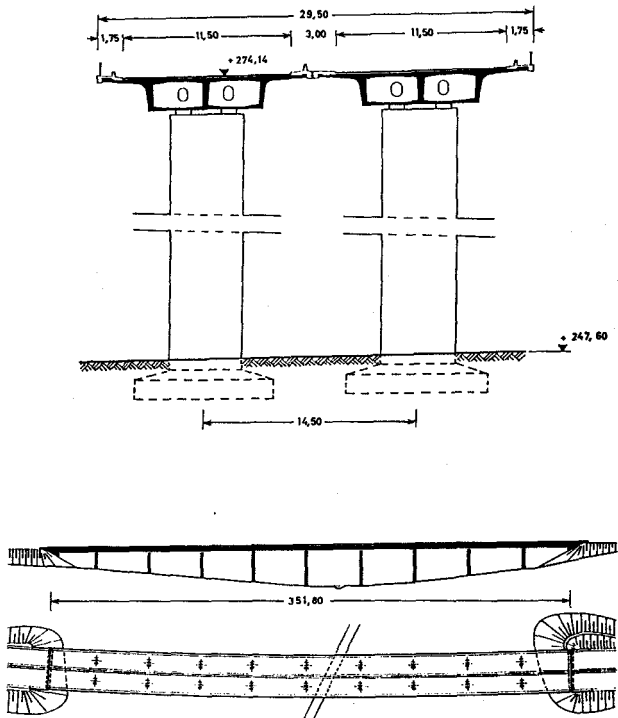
Ort beton-Autobahnbrücke mit einem zweizelligen Hohlkasten als Überbauquerschnitt und Spannweiten von ca. 40 m
